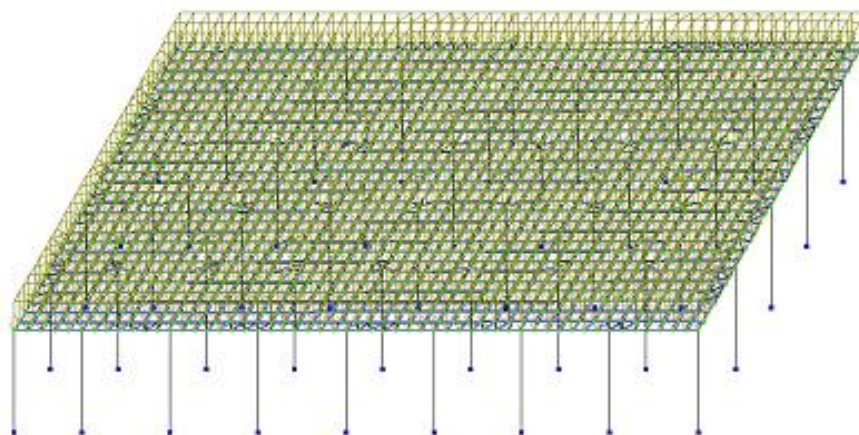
Расчетная схемы плиты перекрытия с приложением всех видов нагрузок
